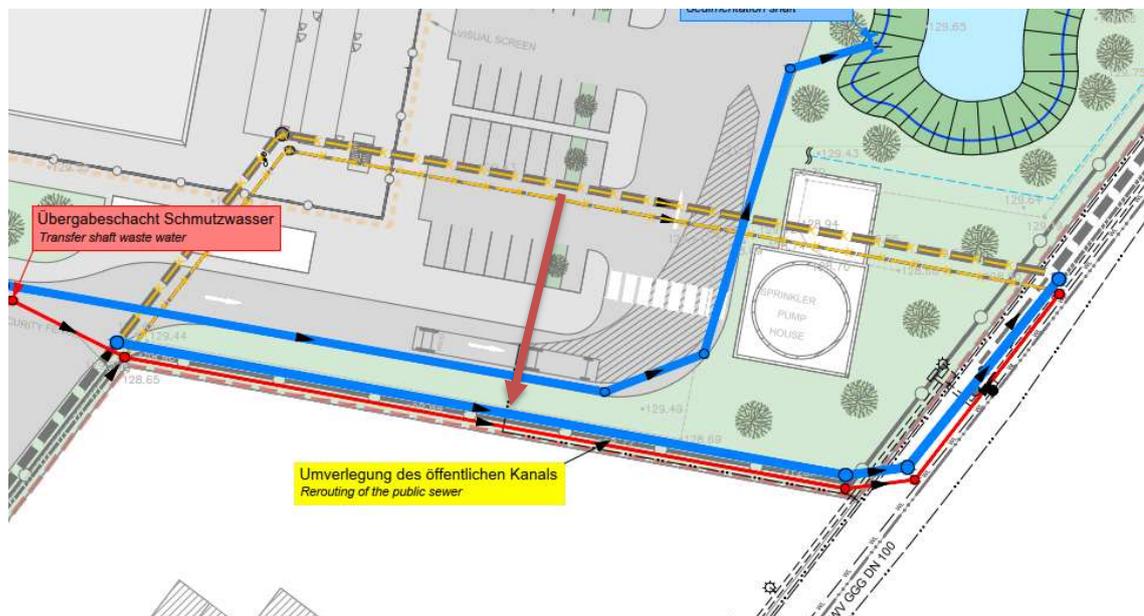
Auszug Bereich Kanalumverlegung Lageplan Anlage 1
